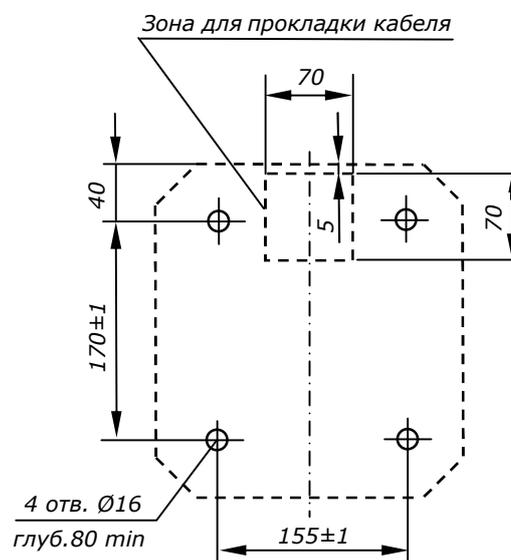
Разметка отверстий в полу для крепления стойки турникета.
